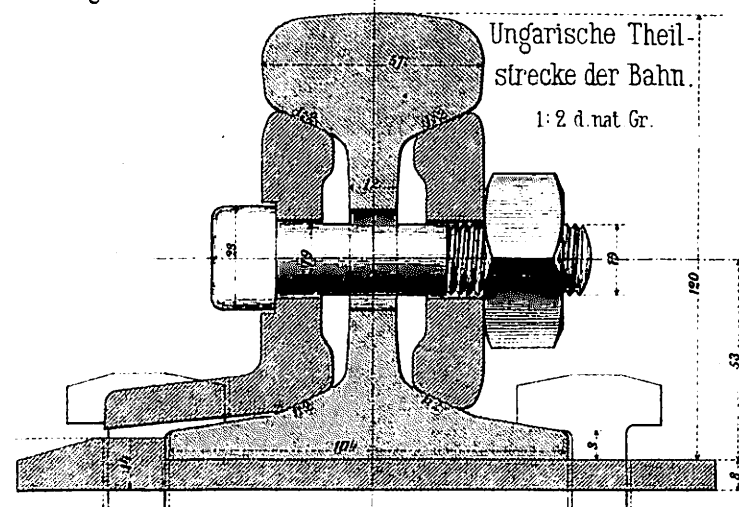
Für Hauptbahnen mit hölzernen Querschwellen.
